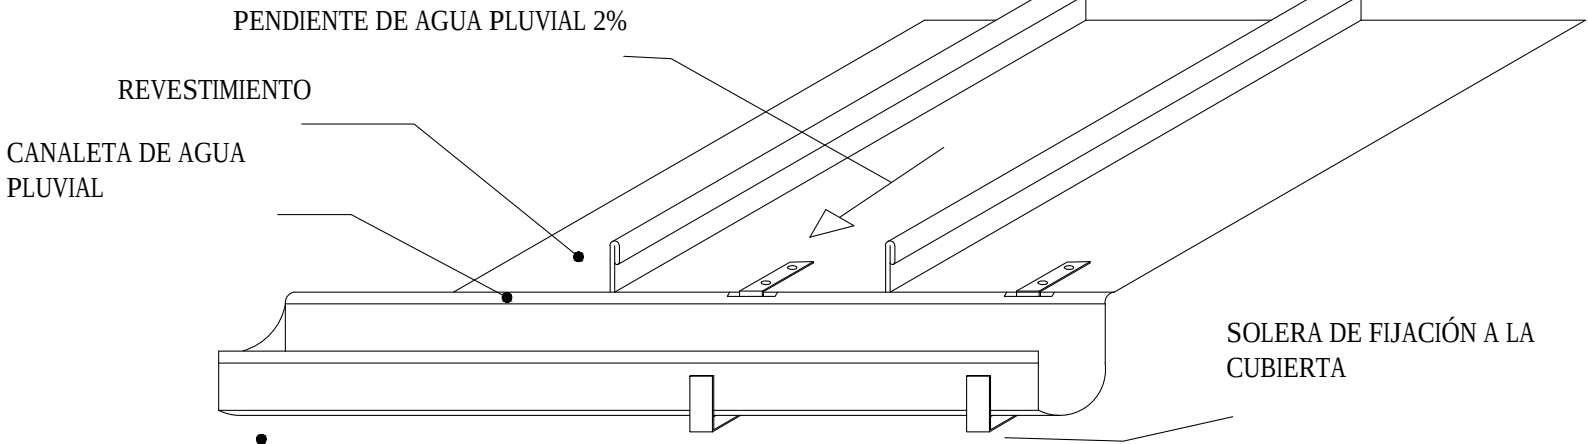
Detalle en planos del sistema de canaletas empleado para la captación de água pluvial
